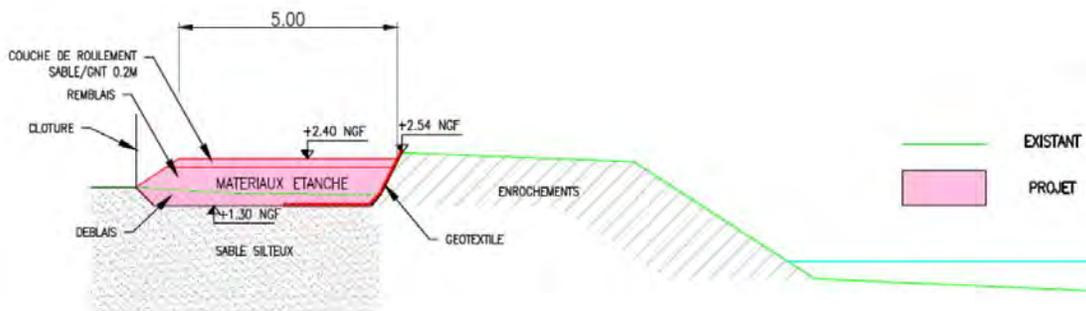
coupe type de la rehausse du niveau d'étanchéité dans le secteur du Clos du Rhône (source : AVP EGIS)
